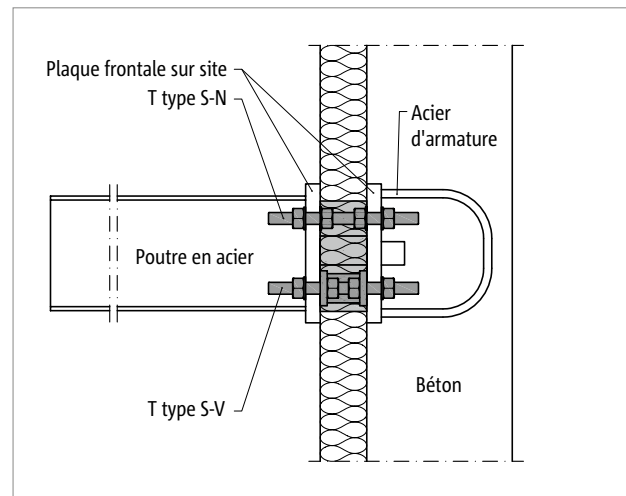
Schöck Isokorb® T type S-N et T type S-V : raccordement de structure en acier sur béton
